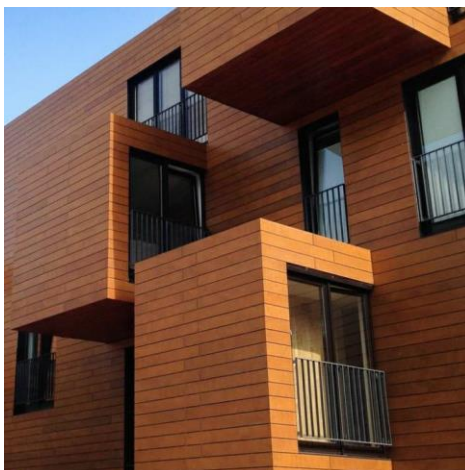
Fachada ventilada com revestimento externo em ACM
